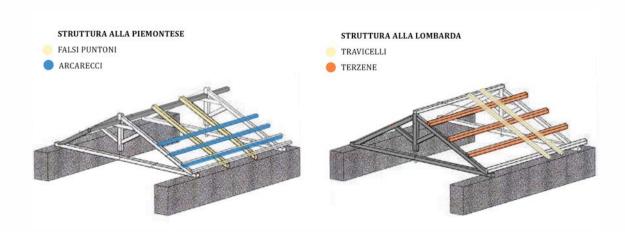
Struttura alla Piemontese Schema strutturale
